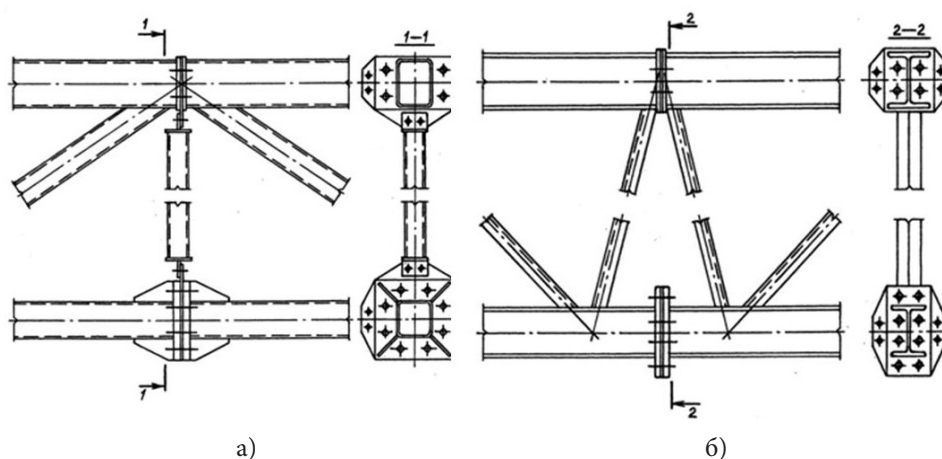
Схемы монтажных стыков стропильных ферм (ферм покрытий) с использованием фланцевых соединений на болтах: а – из замкнутых профилей; б – из открытых профилей
